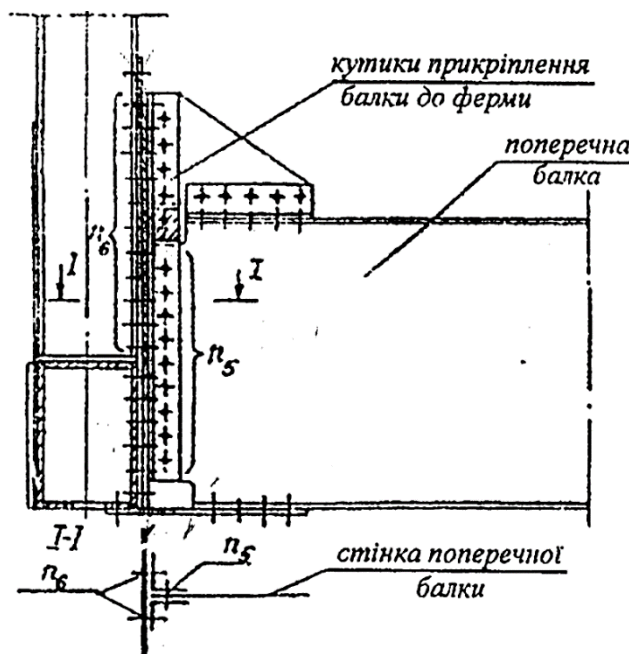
Прикріплення поперечної балки до поясу головної ферми
